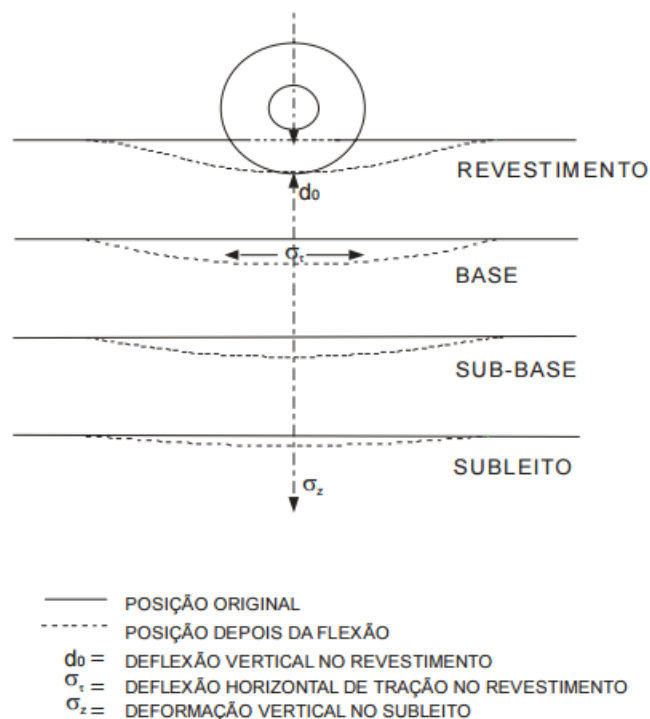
Deformações no pavimento ou deflexões (DNIT, 2006).
